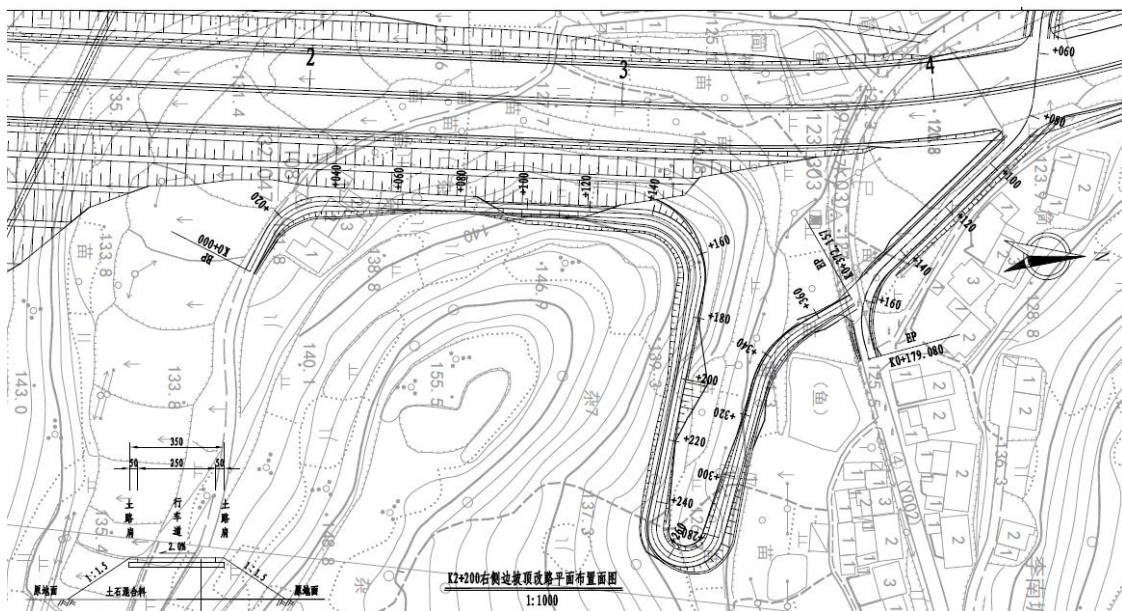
K2+200 右侧边坡顶-改路平面布置图
